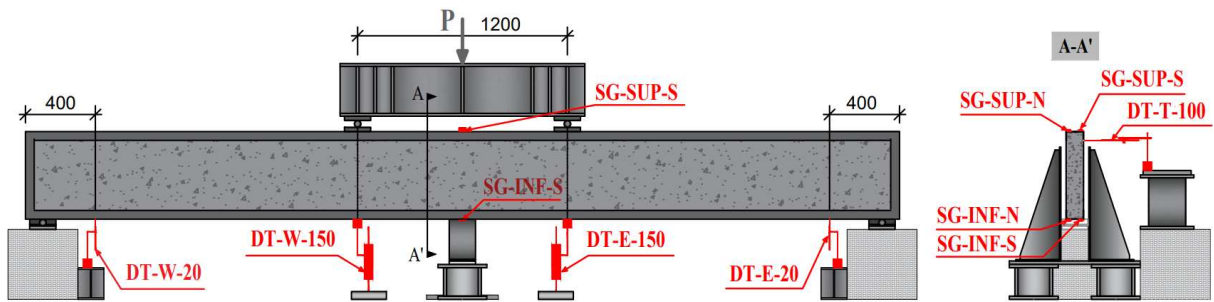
Ensaio experimental das vigas de concreto pré-moldado envelopadas (LBE/UFV).
